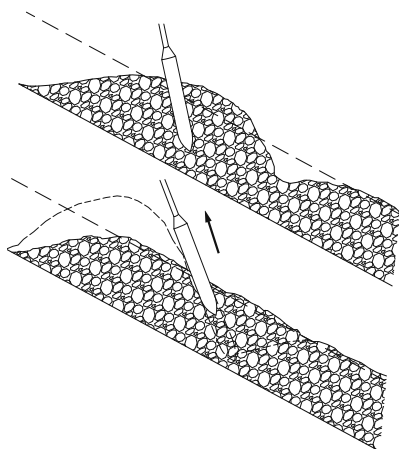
El hormigón se extiende de abajo hacia arriba por roscas, que tras una ligera aplicación del vibrador ocupa su lugar definitivo.
